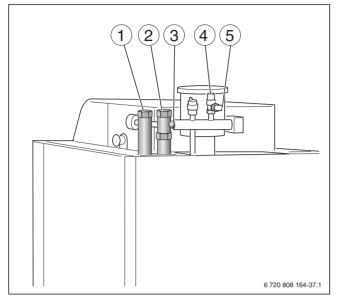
Rückansicht des Heizkessels (ohne 3-Wege-Ventil)
